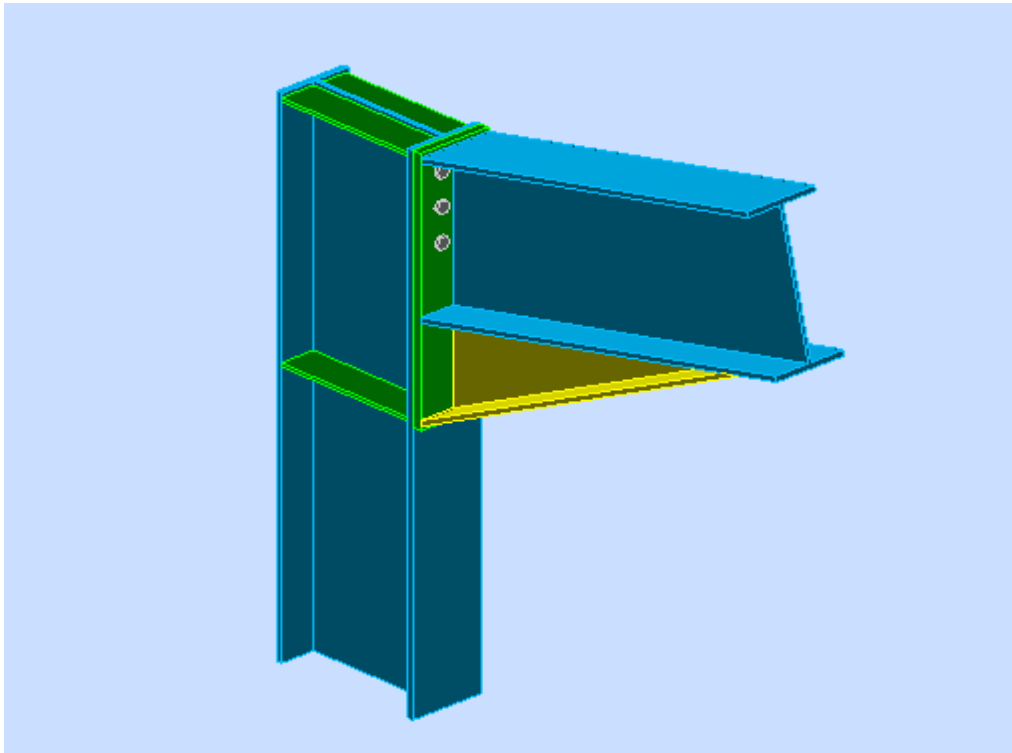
assemblage poteau IPE 360-poutre IPE 360 en 3D
